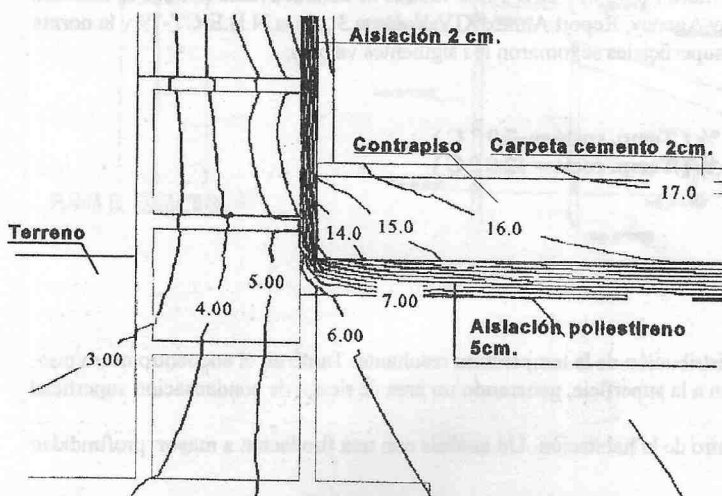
Encuentro muro / suelo, aislado interiormente.
